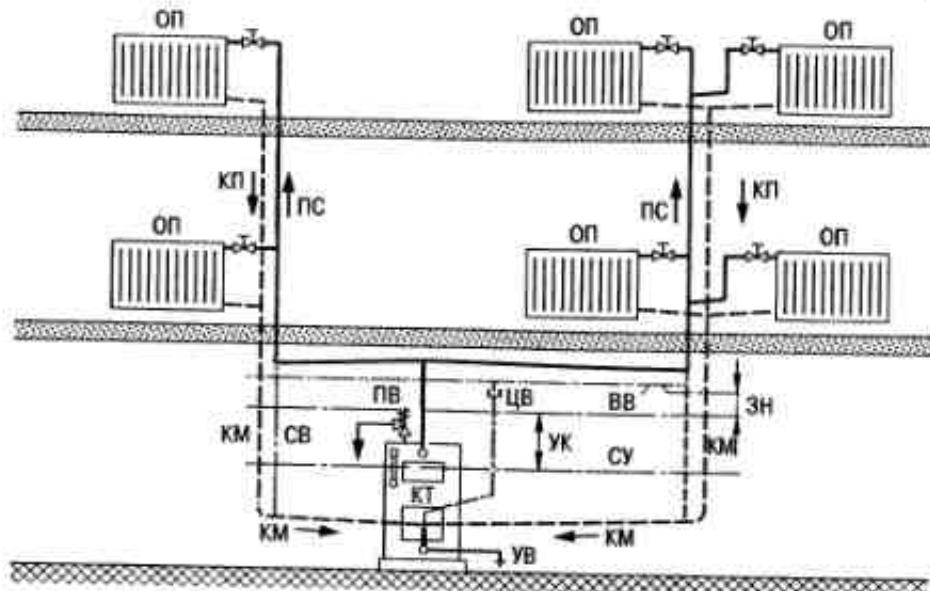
Нижняя разводка с мокрым конденсатопроводом [4.1]:
